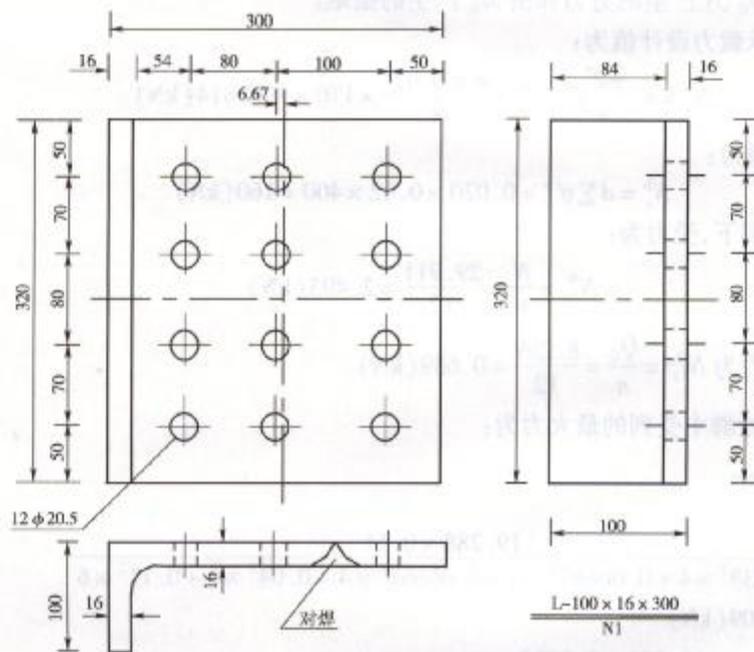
立柱与横梁连接图(尺寸单位:mm)
